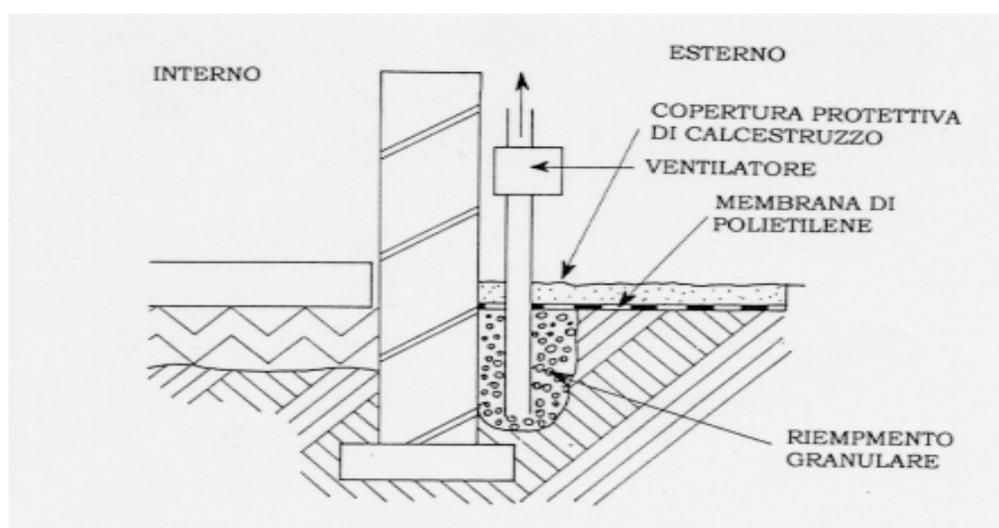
Questa soluzione prevede che il pozzetto sia scavato all'esterno. Lo svantaggio è rappresentato dal fatto che il raggio di azione di questo sistema aspirante risulta in parte attivo in un'area non interessata dall'edificio. In questo caso sarebbe opportuno coprire il terreno sopra il pozzetto interrando una membrana in polietilene per evitare una eccessiva aspirazione di aria dall'atmosfera
